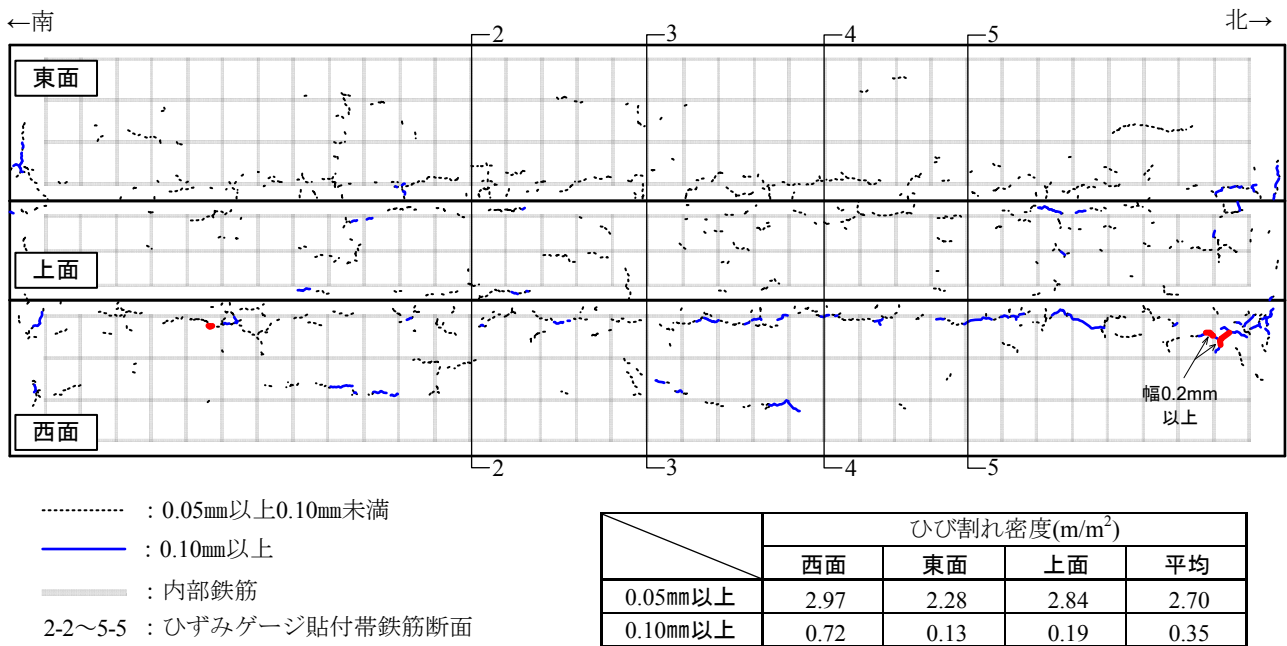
ひび割れ状況展開図(No.4供試体)
